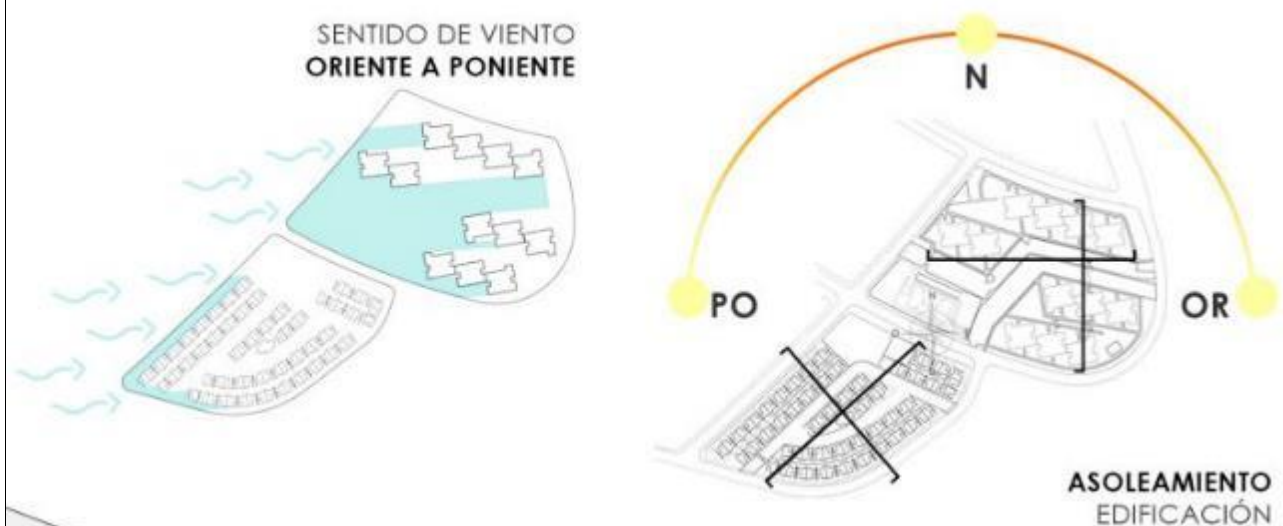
Ejemplo de asoleamiento intervención PUH Llanos de la Candelaria etapa 1, tipología mixta (norte - sur).
